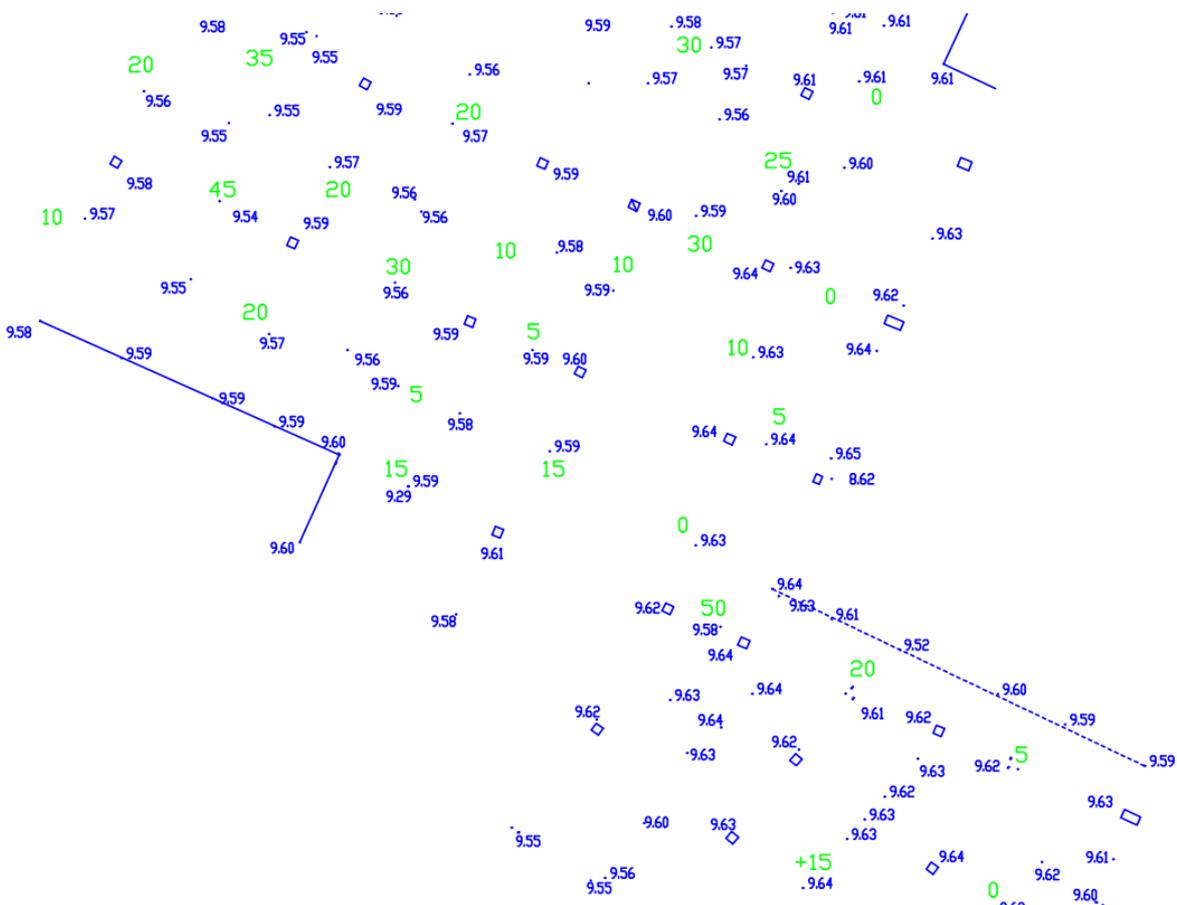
Фрагмент исполнительной схемы фактического положения низа плиты перекрытия
